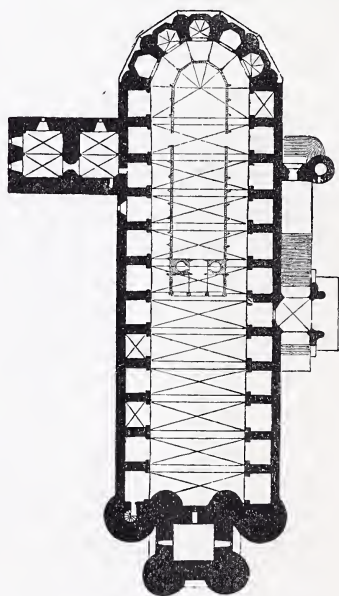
Grundriss der Kathedrale zu Alby.
